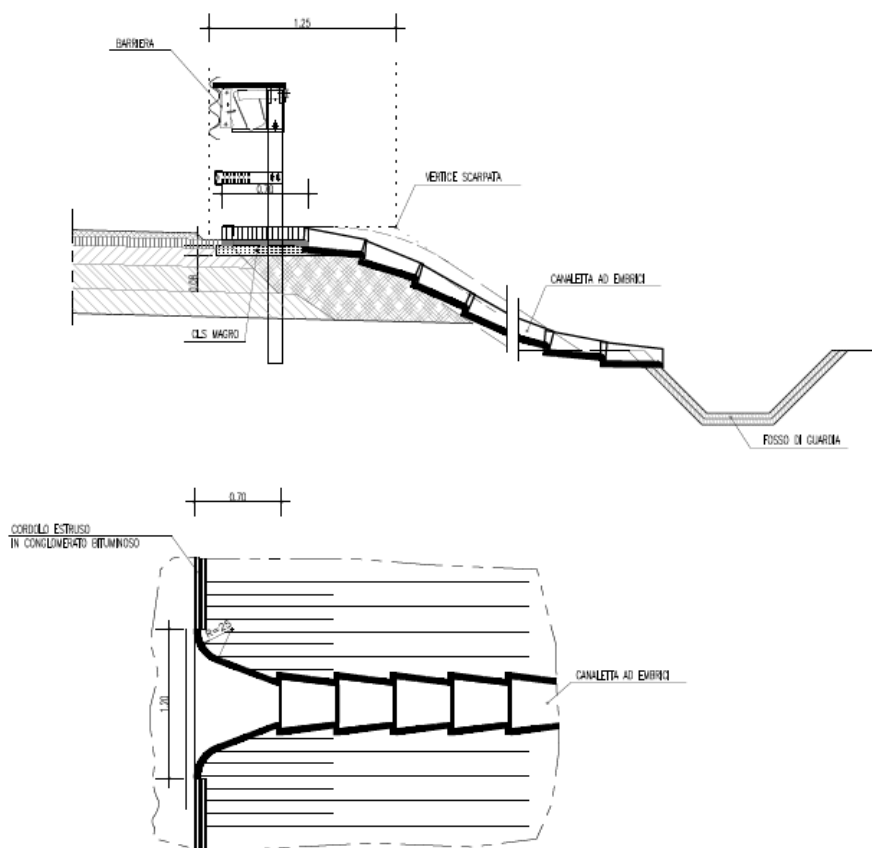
Particolare costruttivo dello scarico con canaletto ad embrici.
